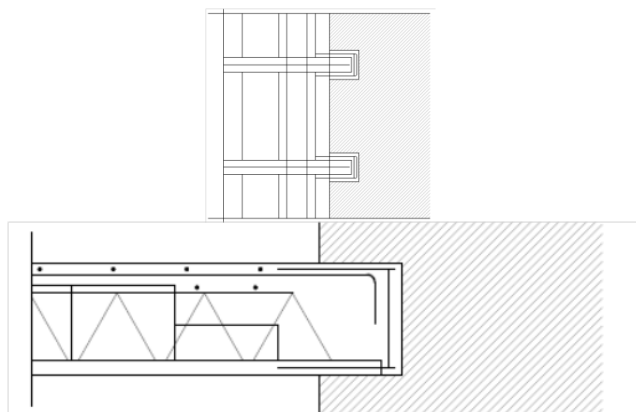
Apoyos de forjado acometiendo a muro de fachada.
